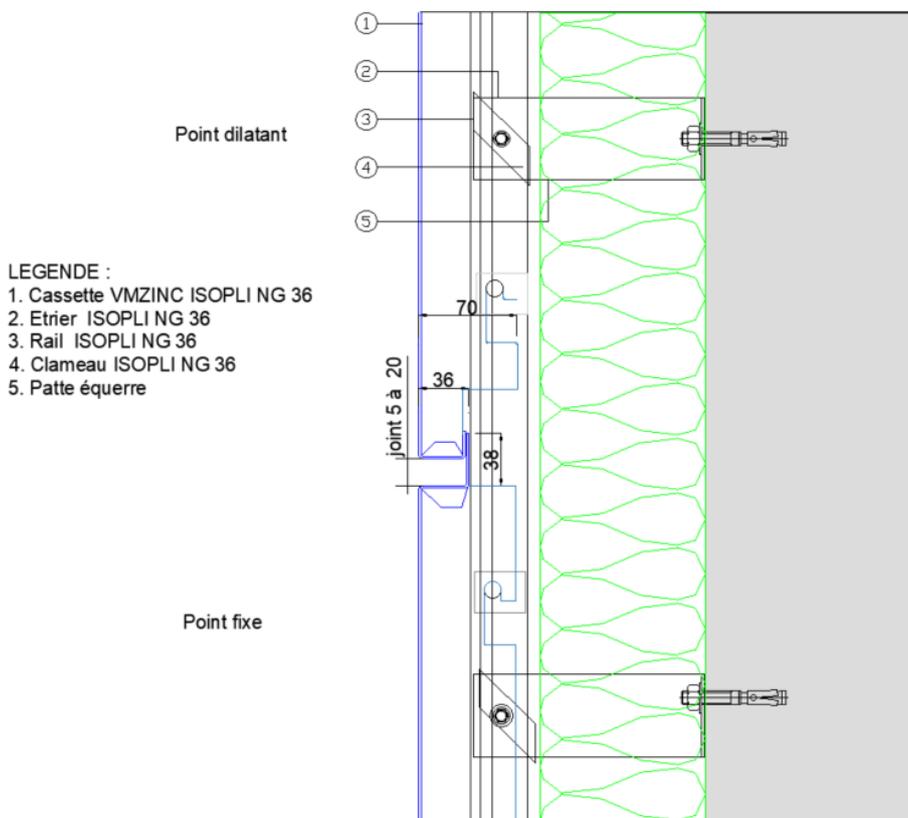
Joint horizontal (coupe verticale) sur cassettes horizontales avec raidisseurs, exemple avec rails ISOPLING de 3 m maximum
